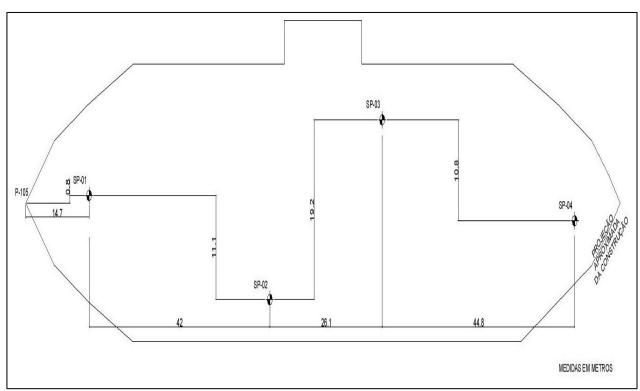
Croqui de dos pontos de sondagem da Empresa 02
